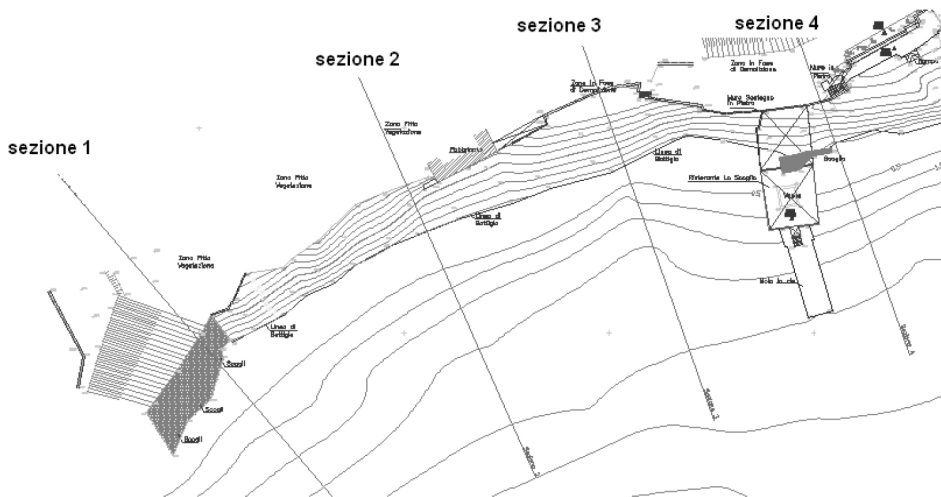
Planimetria di Marina del Cantone (Ovest)
